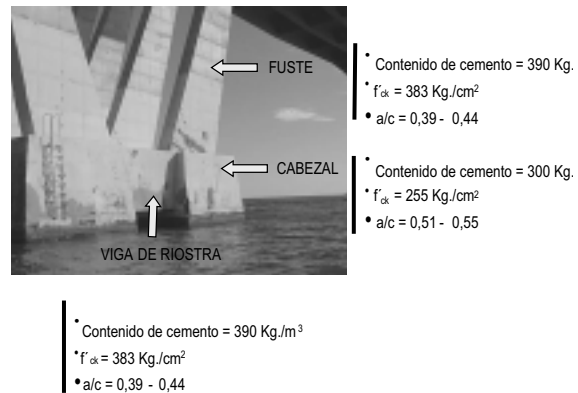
Pila 9. Características generales del concreto en elementos del PGRU.
